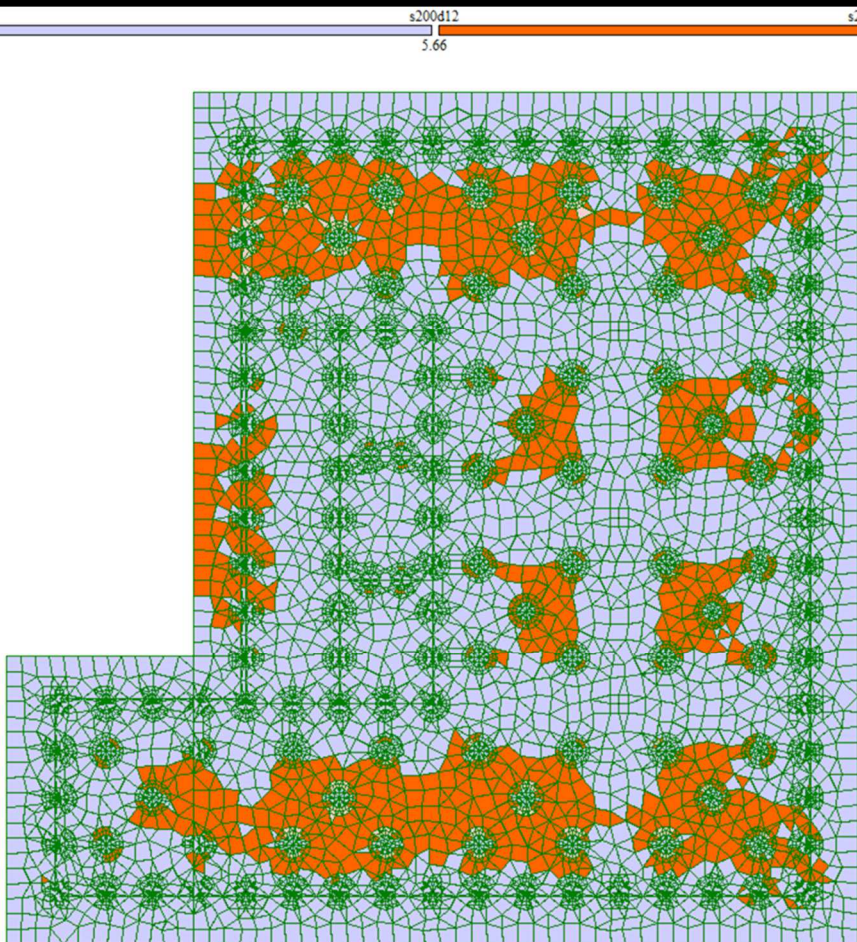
Верхнее армирование фундаментной плиты по направлению x
